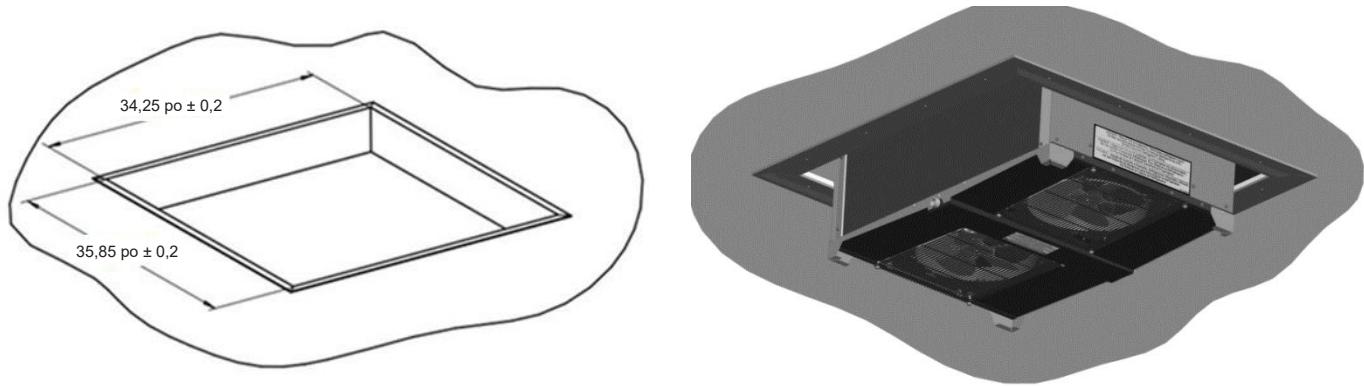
Dimensions de l'ouverture pour l'installation (en pouces) et suggestion d'assemblage des garnitures
